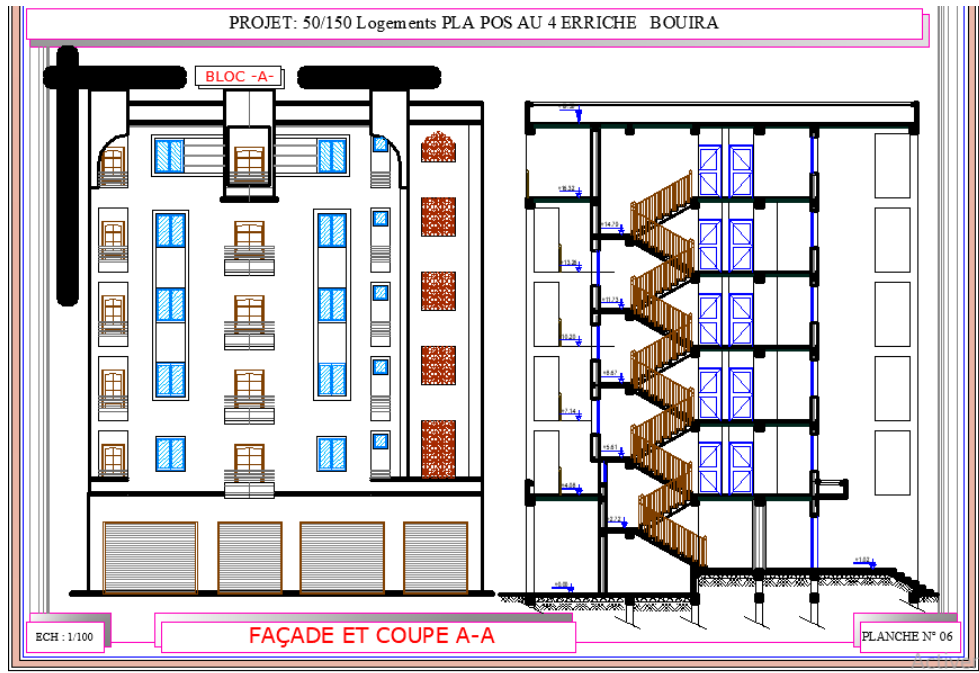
Plan de façade et coupe A-A du bloc A
